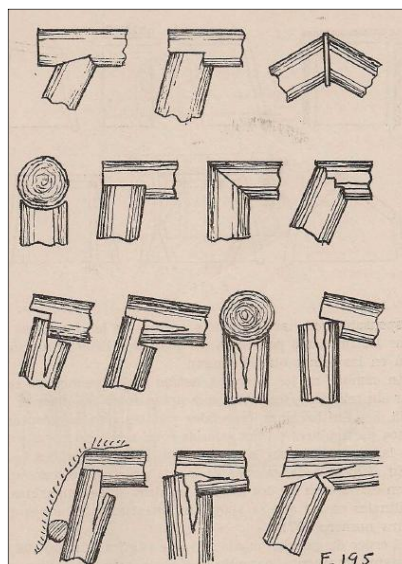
Ensamblajes y Rupturas de la madera.
